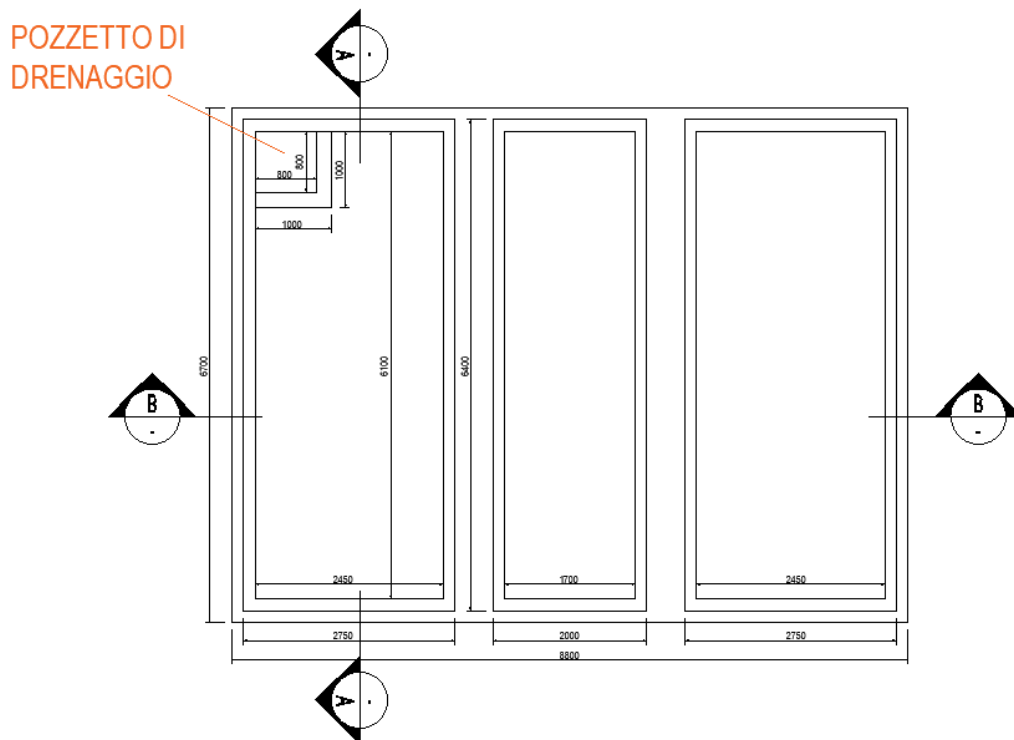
Planimetria vasca di fondazione trasformatore SSE
